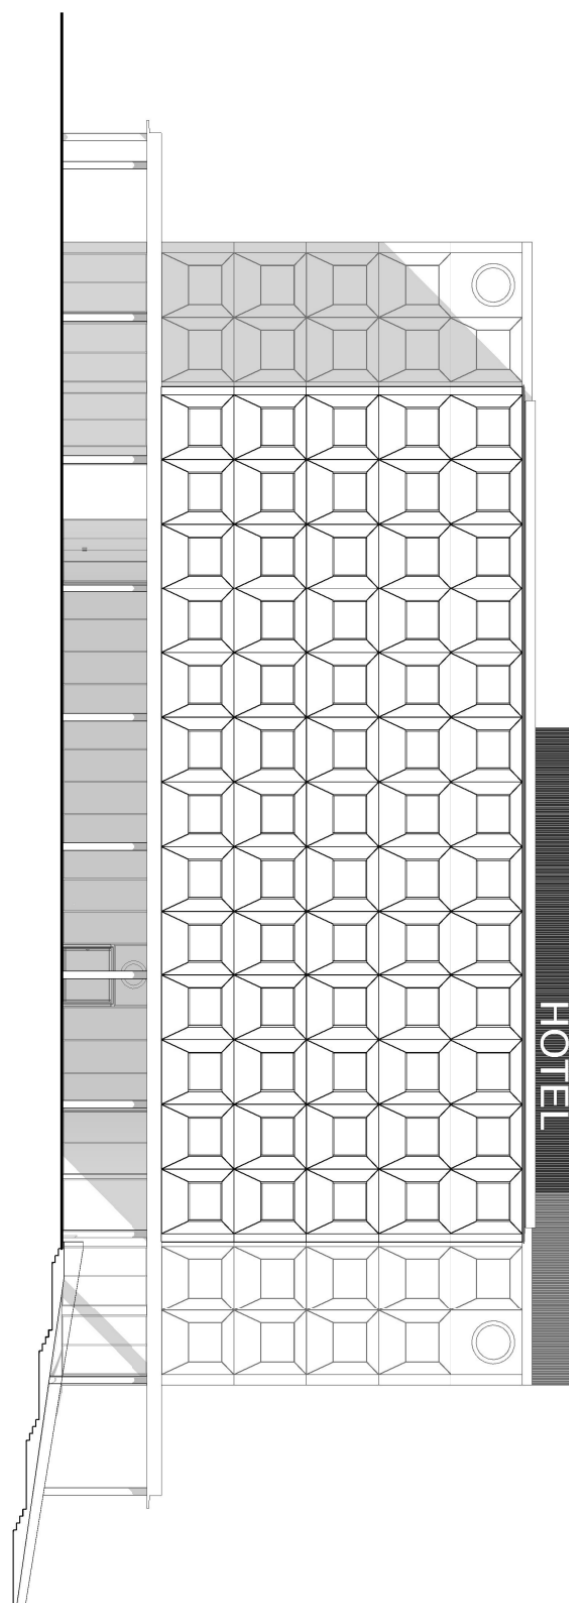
Alçado da fachada principal - Hotel "Tres Cantos" em Madrid (sem escala)
